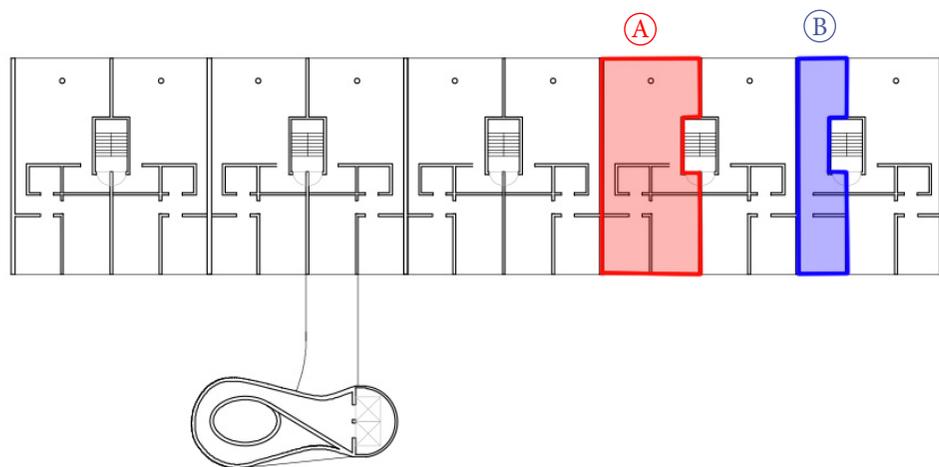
Esquema de la planta tipo indicando las distintas tipologías de vivienda.
